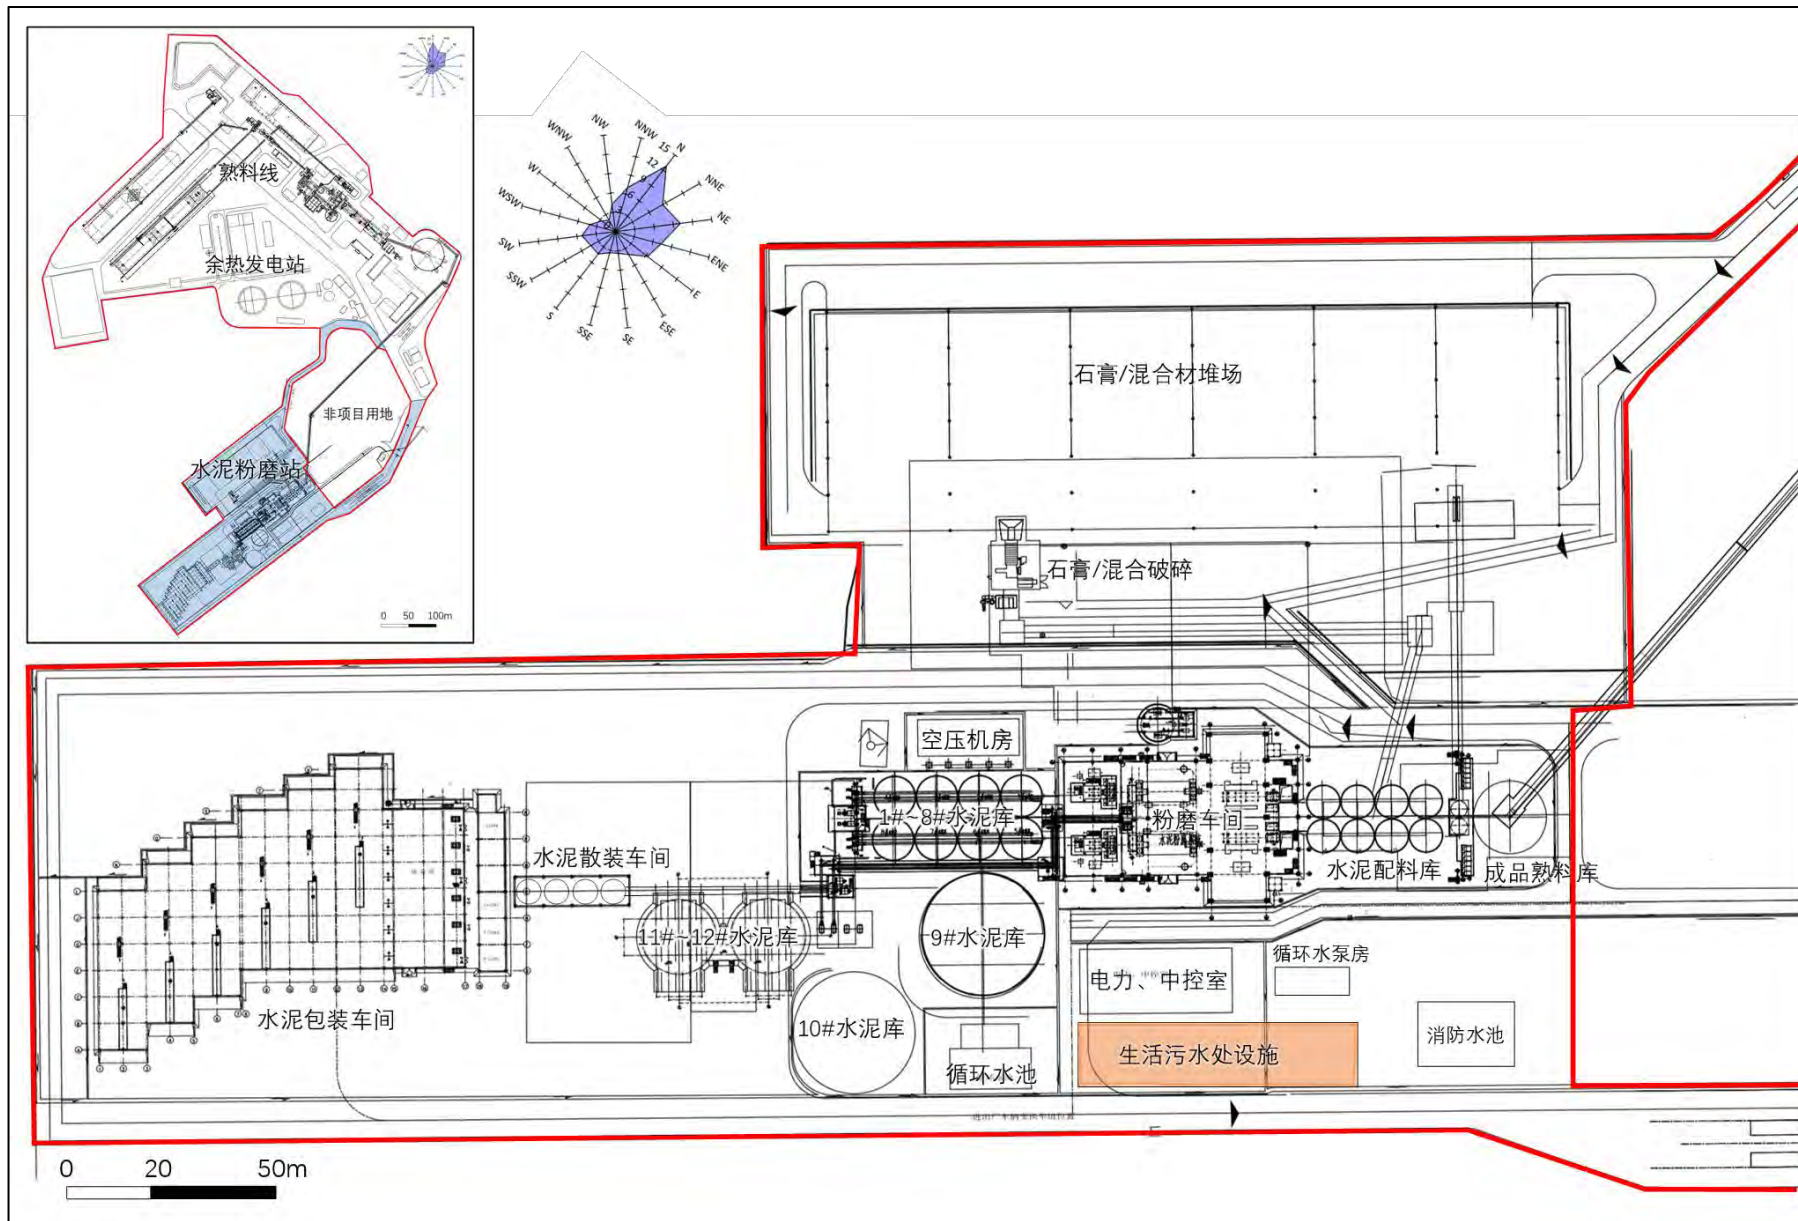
现有项目水泥粉磨站平面布置图
